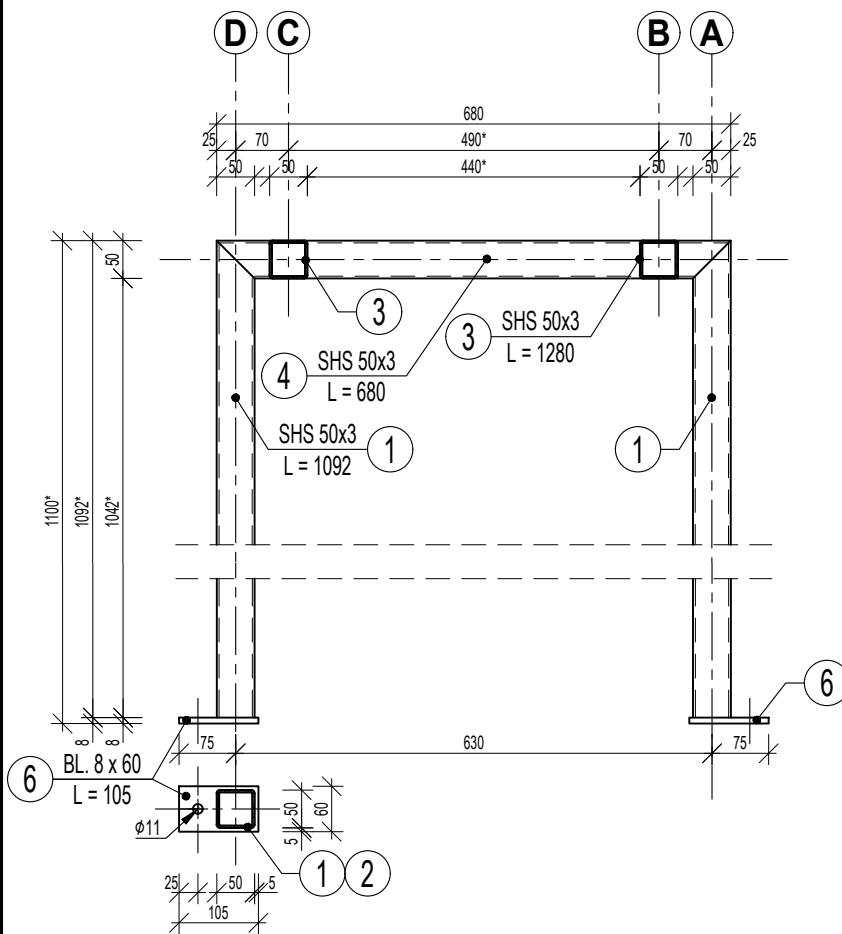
KONSTRUKCJA WSPORCZA WENTYLATORÓW DACHOWYCH KW-1
